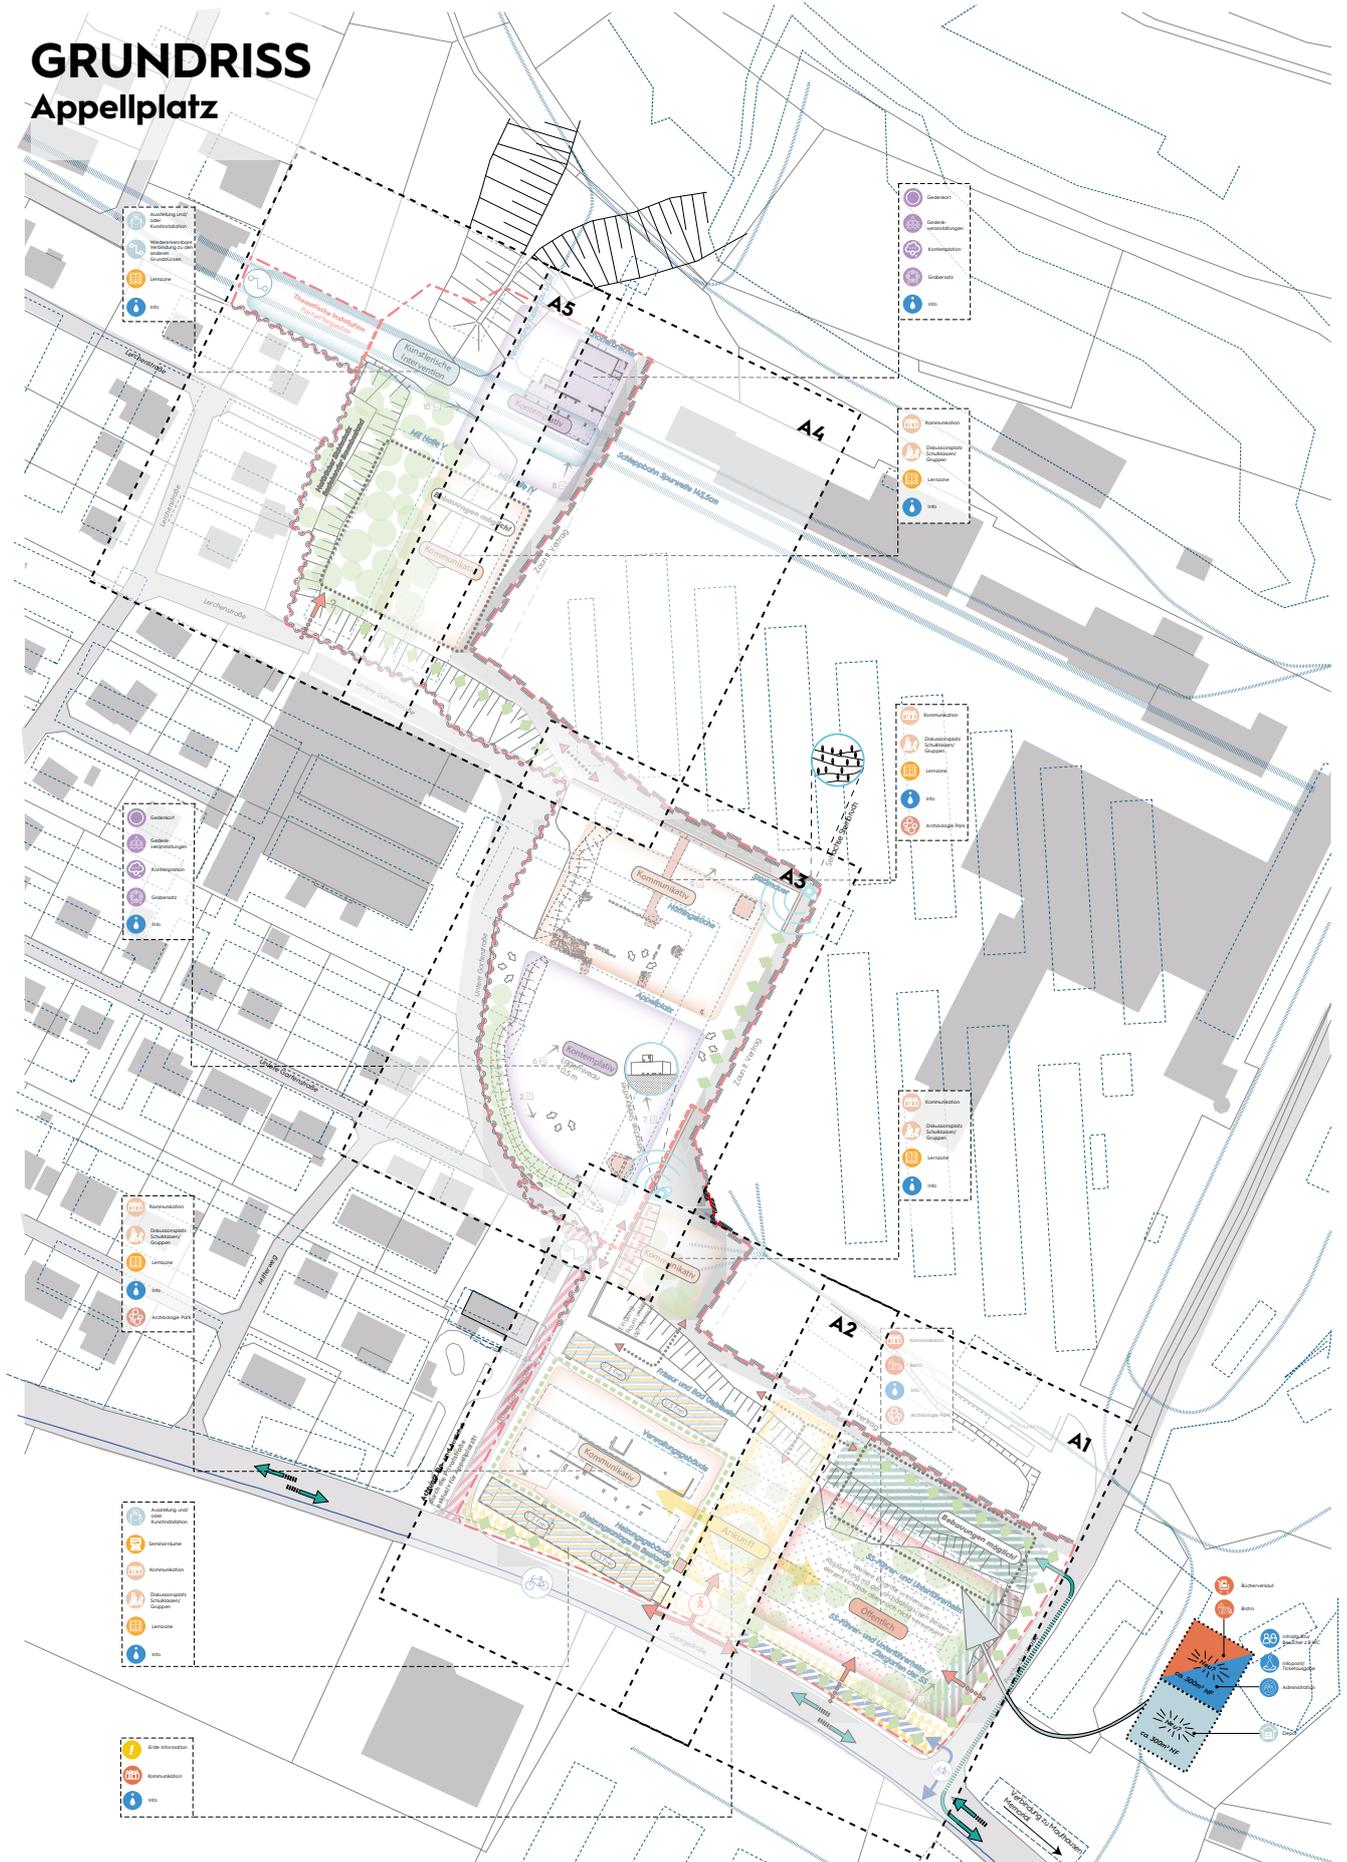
Masterplan Grundriss Appellplatz (Ausschnitte A1 bis A5 werden auf den Folgeseiten dargestellt)
